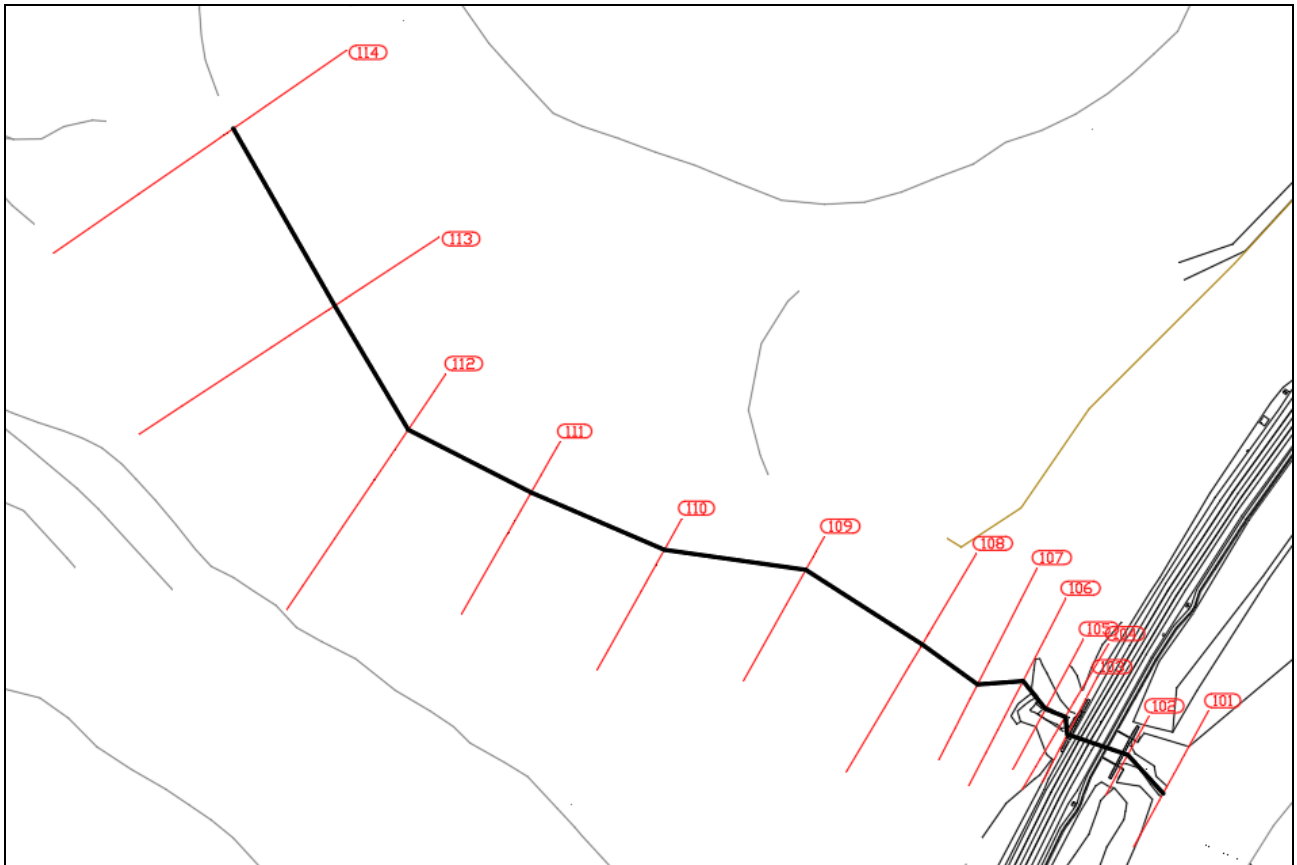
Schema planimetrico dell'asse IN02 e delle sezioni trasversali in condizioni Ante Operam
